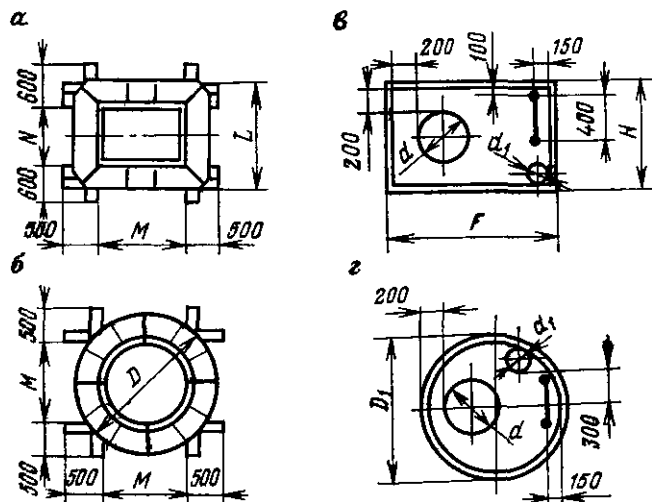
План (а, б) и поперечное сечение (в, г) шурфов прямоугольной и круглой формы при использовании крепи типа КШП, КШИ (план и поперечное сечение изображены в разных масштабах)
